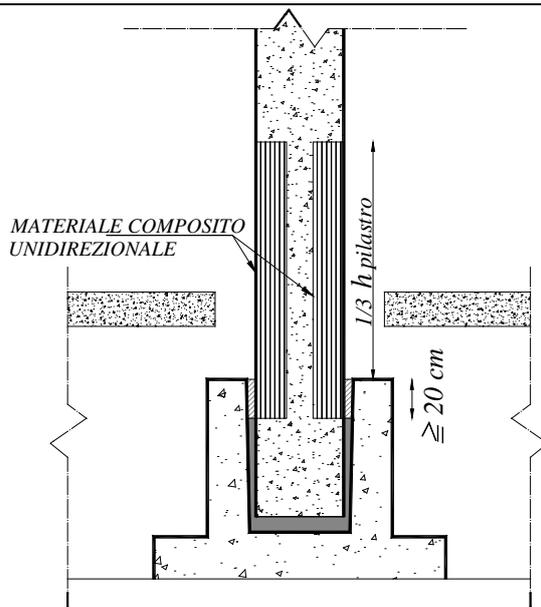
Applicazione del materiale composito unidirezionale. Sezione verticale
